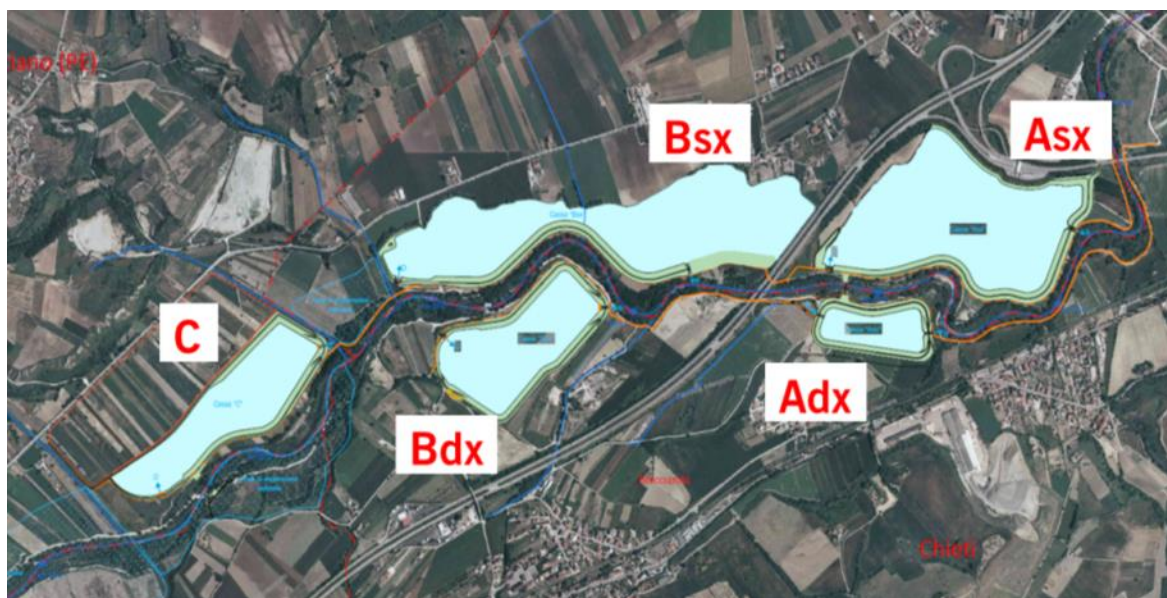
Vista dell'area interessata dall'intervento (i codici indicano la posizione delle casse)
